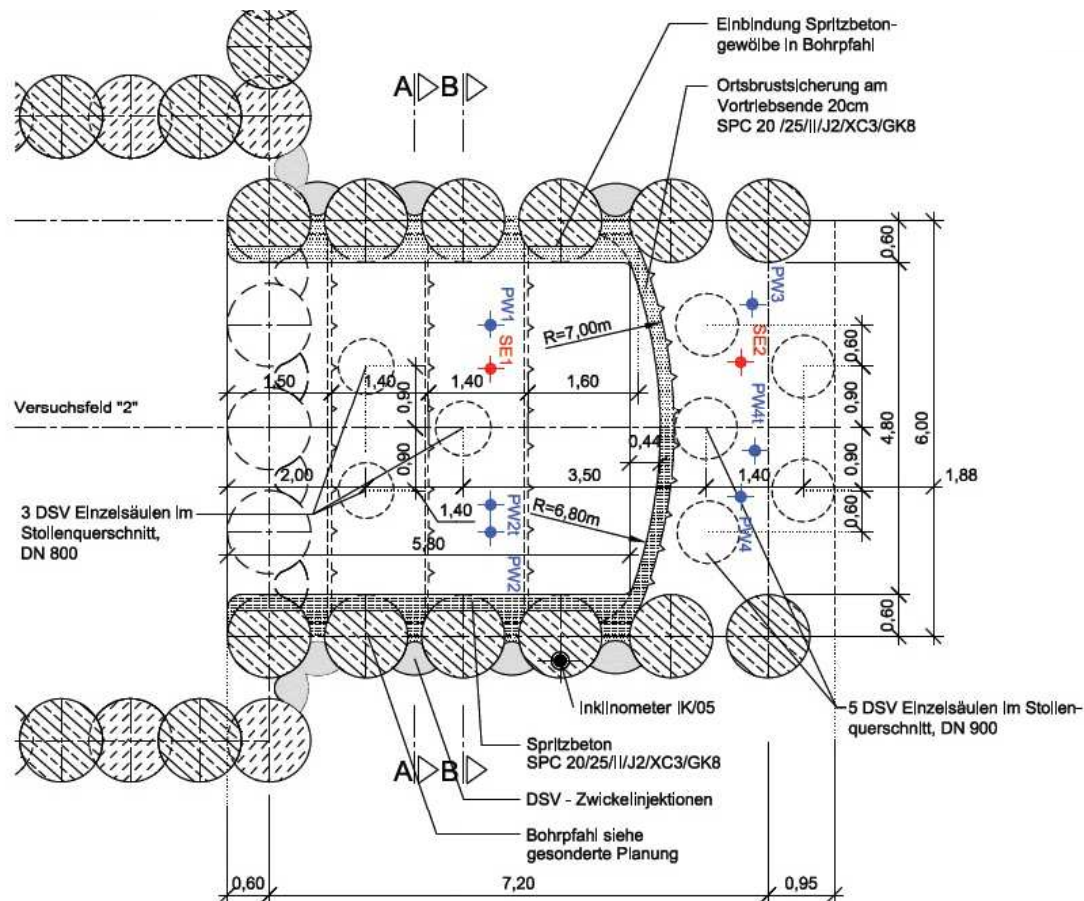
Tunnelprobenvortrieb - Grundriss
